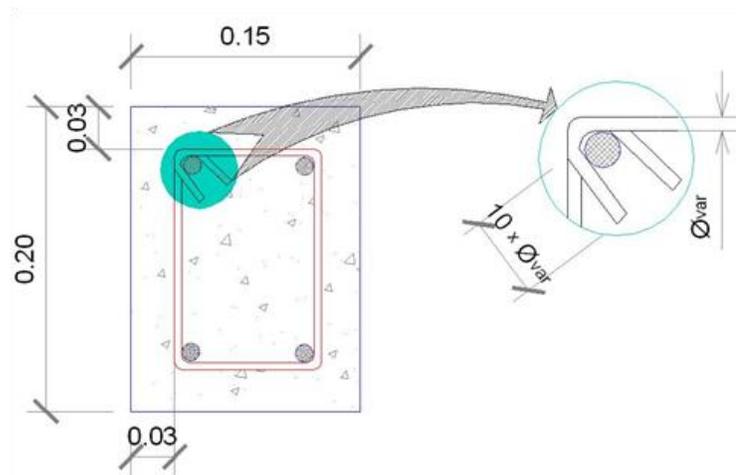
SECCION DE PEDESTAL Y DETALLE DE TRASLAPE DE ACERO #2
